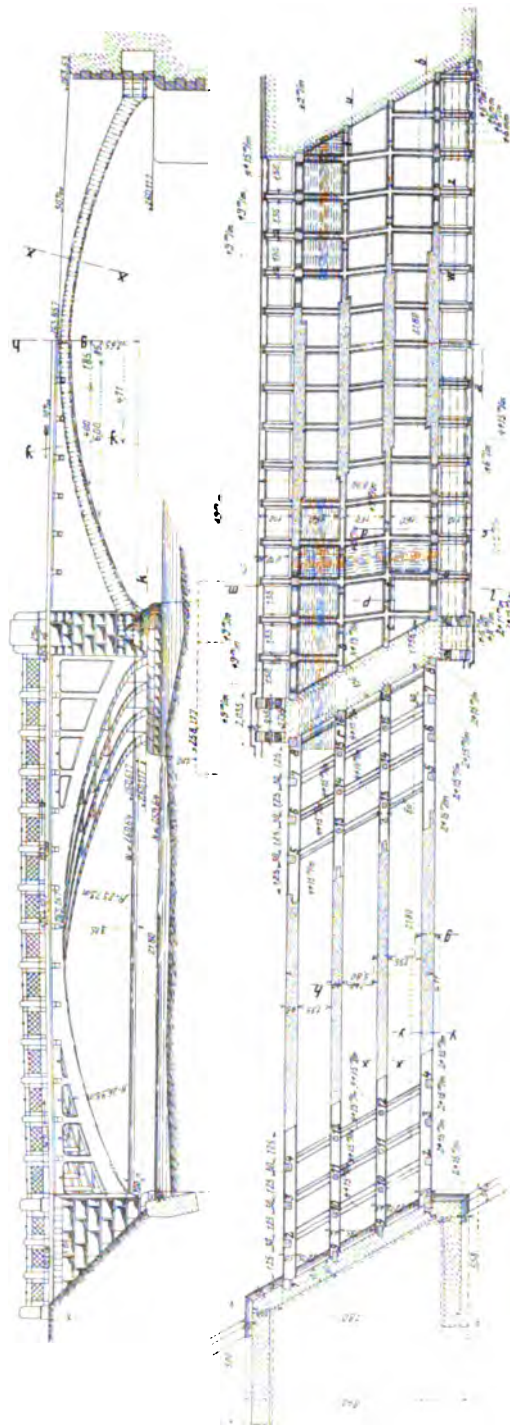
Ansicht, Längenschnitt und Grundriß der Brücke in Trembowla.
